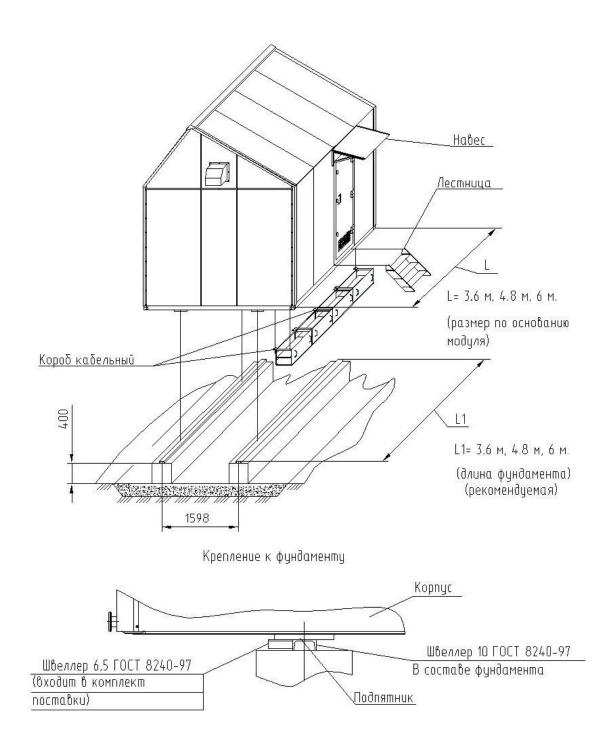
Установка корпусов на типовые фундаменты. Установка на бетонный ленточный фундамент.
